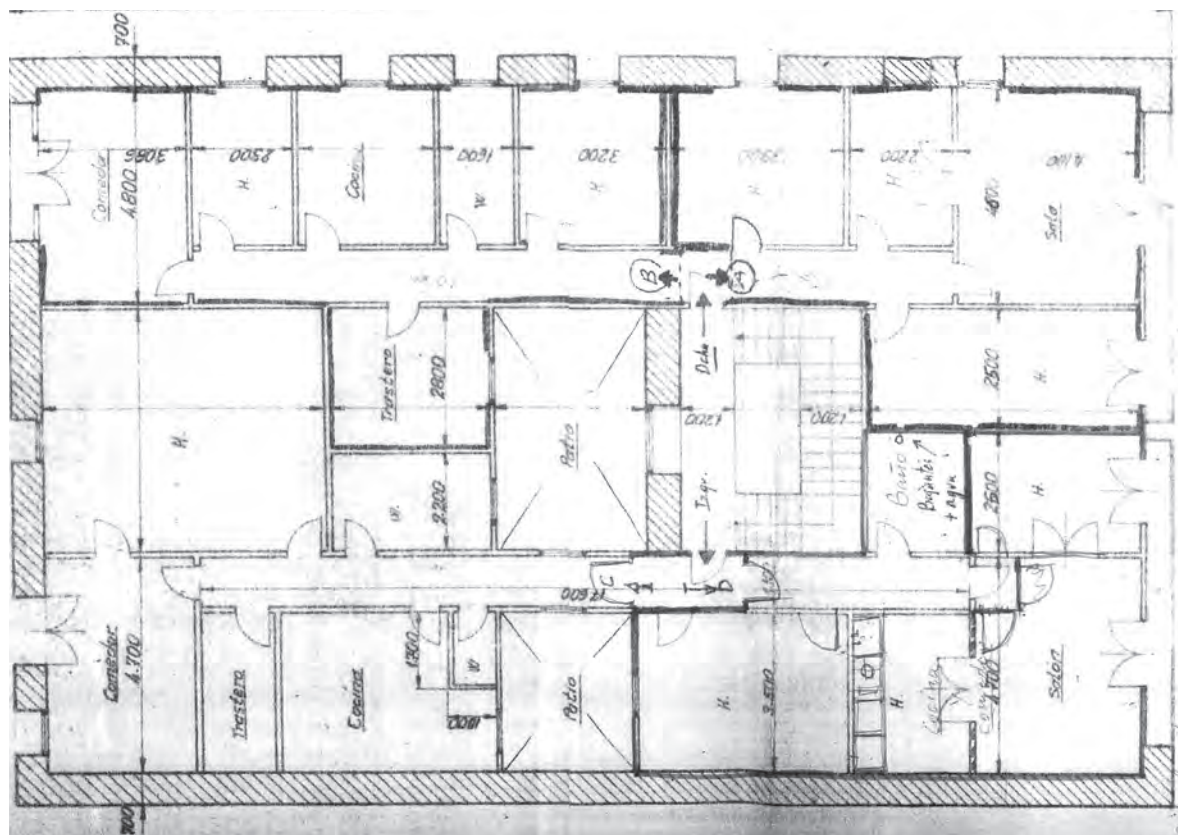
39. PLANO DE LA PLANTA PRIMERA EN 1988³³
